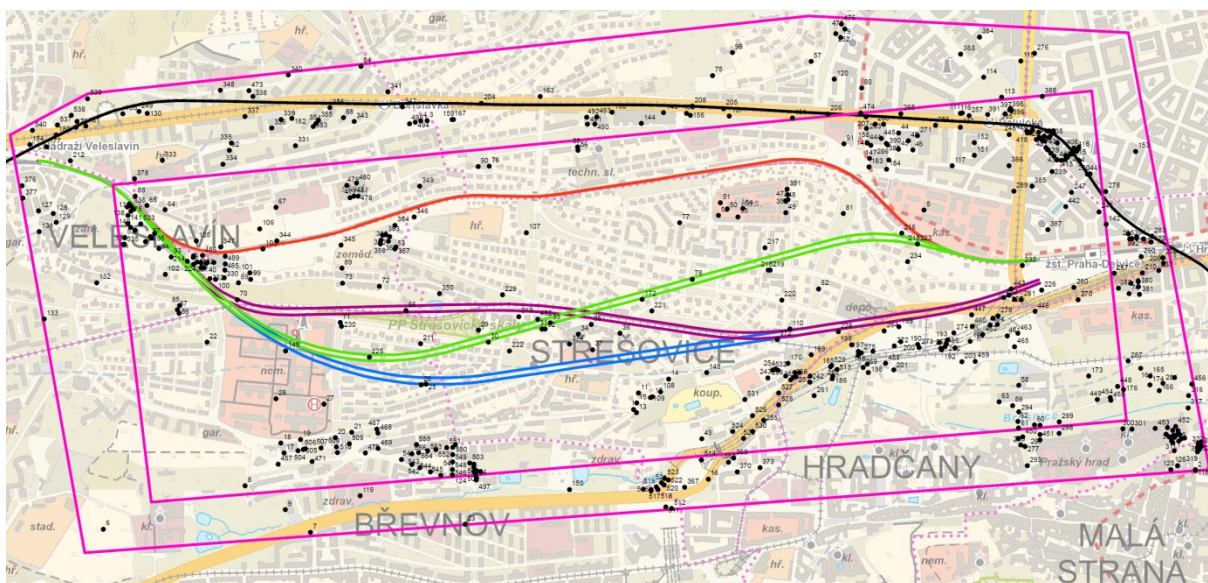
Vedení ražených variant tunelů železničního spojení Praha-Dejvice – Praha-Veleslavín, varianta JIH modře, varianta STŘED oranžově ve vztahu k územnímu systému ekologické stability, limitám území a významným dopravním stavbám.
